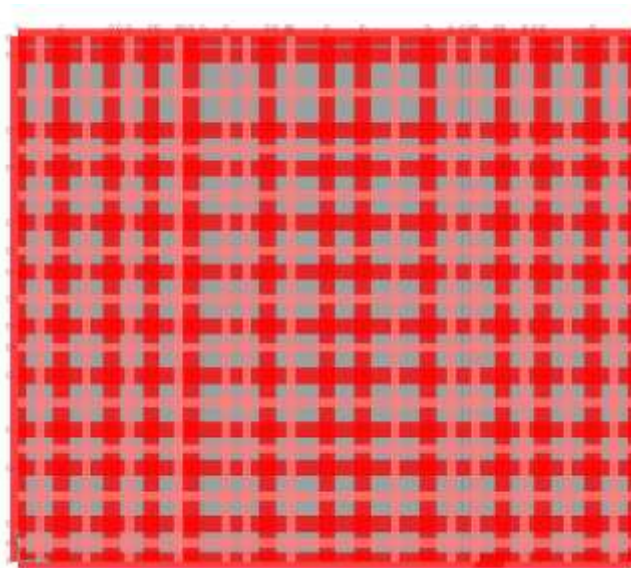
Modelo matemático XY de la placa de cimentación edificio en muros de mampostería estructural– Método Winkler
